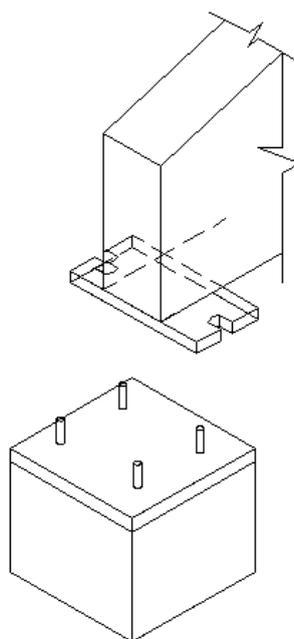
Конструкция соединения ригеля с колонной на анкерных болтах и монтажной сварке.
